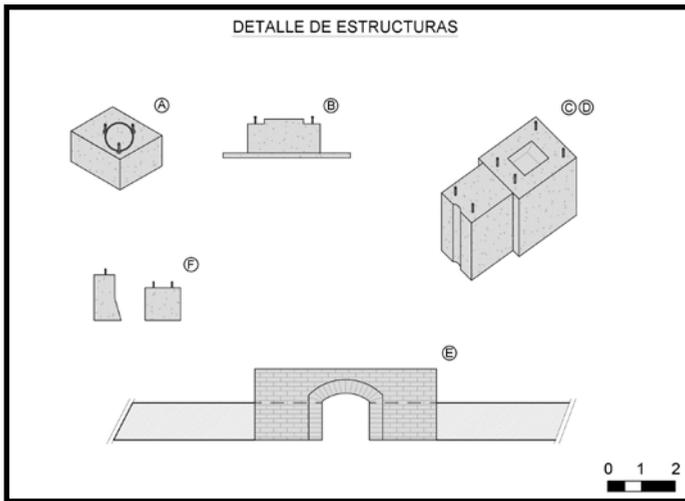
Detalle de las construcciones relevadas en el Saladero Rocca y Cía, tal como se observan en la actualidad.
